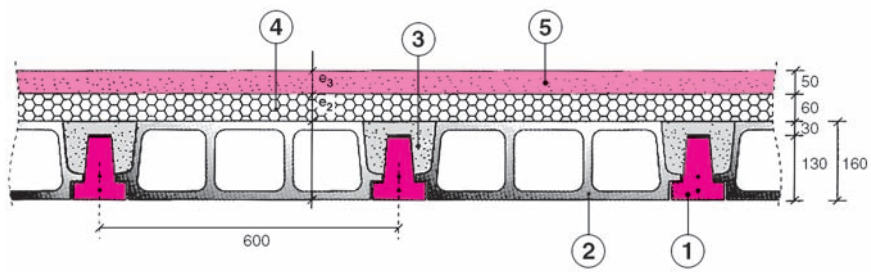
Plancher avec dalle de compression incorporée + dalle flottante
